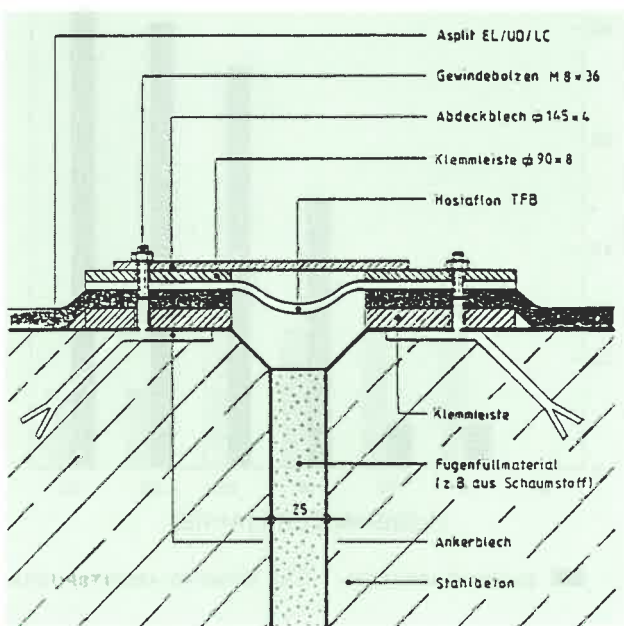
Wartungsfreundliche Fugenkonstruktion
